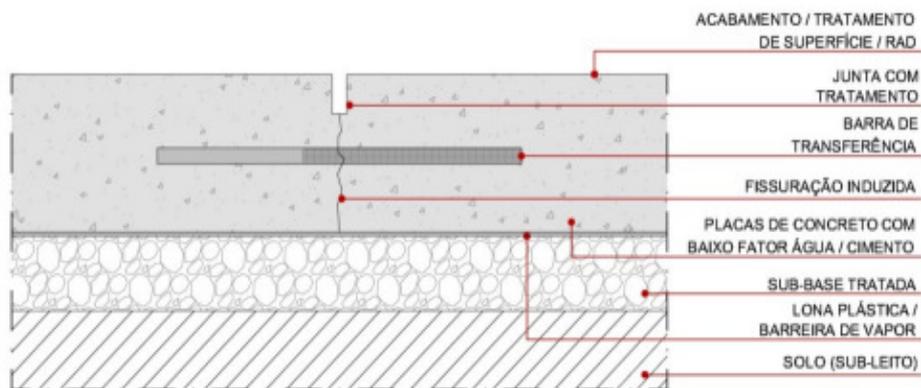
Pavimento de concreto simples com barra de transferência
